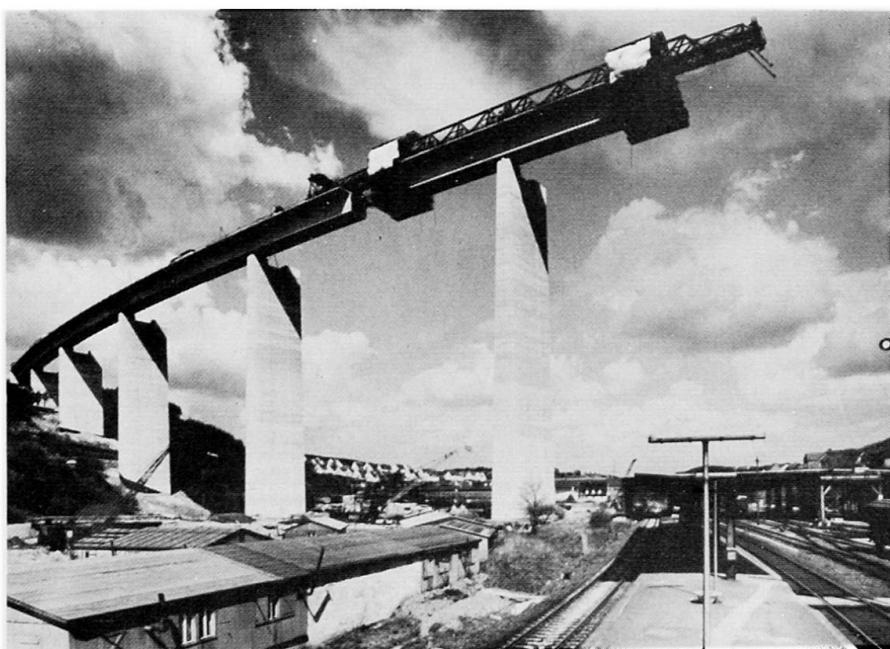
Siegtal-Brücke Eiserfeld. 8)
